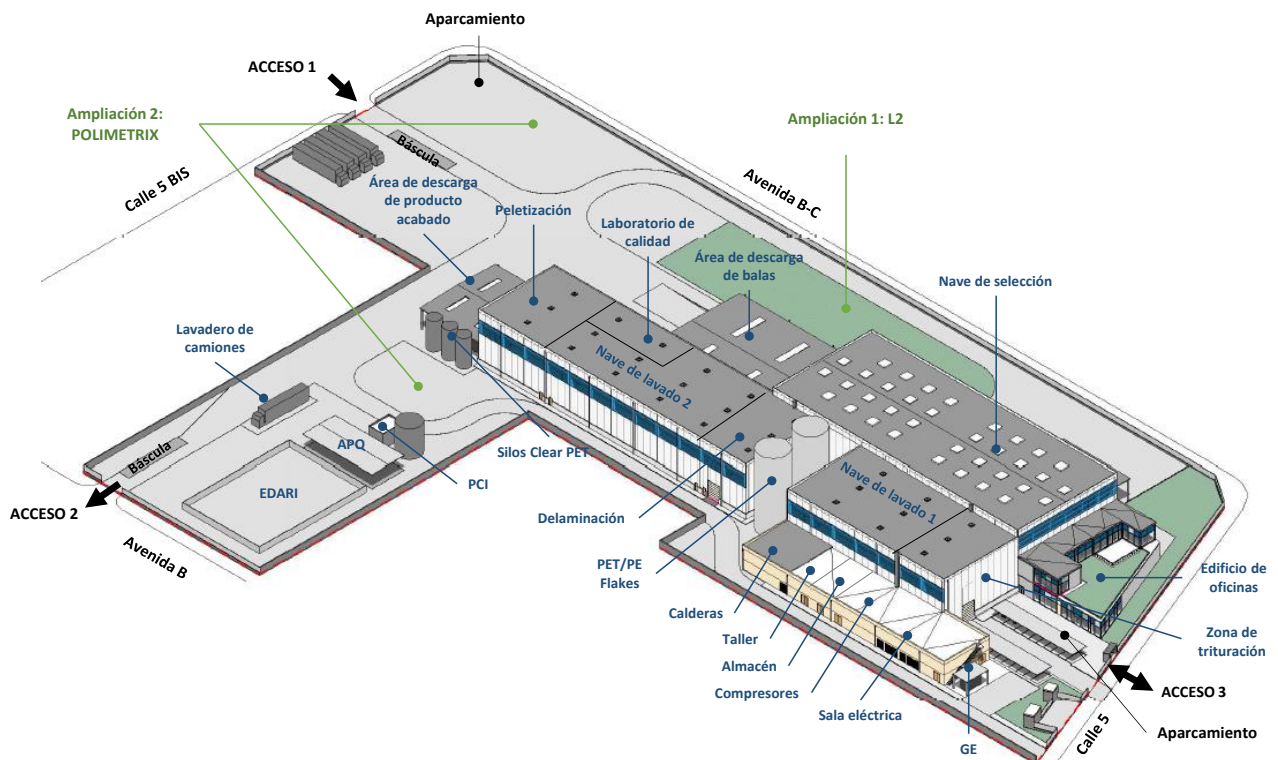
Esquema 3D de las instalaciones de la planta de reciclado de PET laminado.
